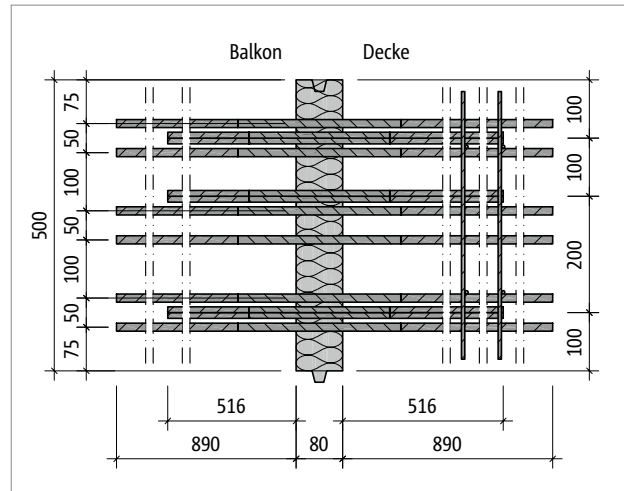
Schöck Isokorb® T Typ DP-MM6-VV3: Grundriss
